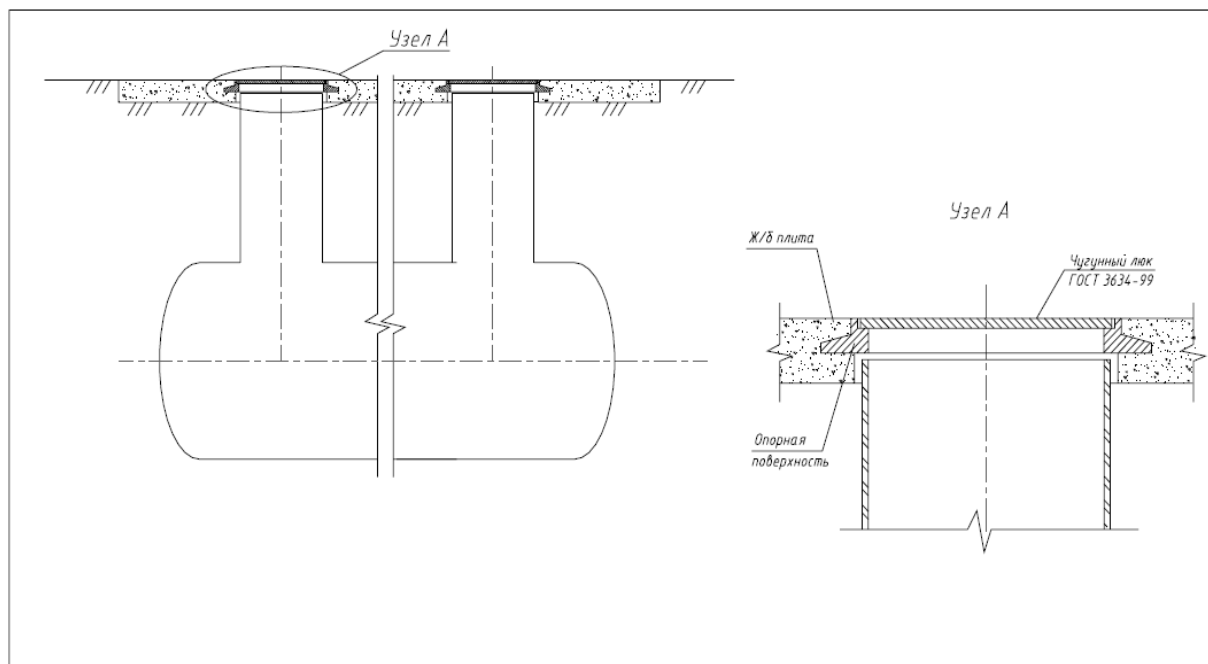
Расположения люков при устройстве железобетонной плиты.
